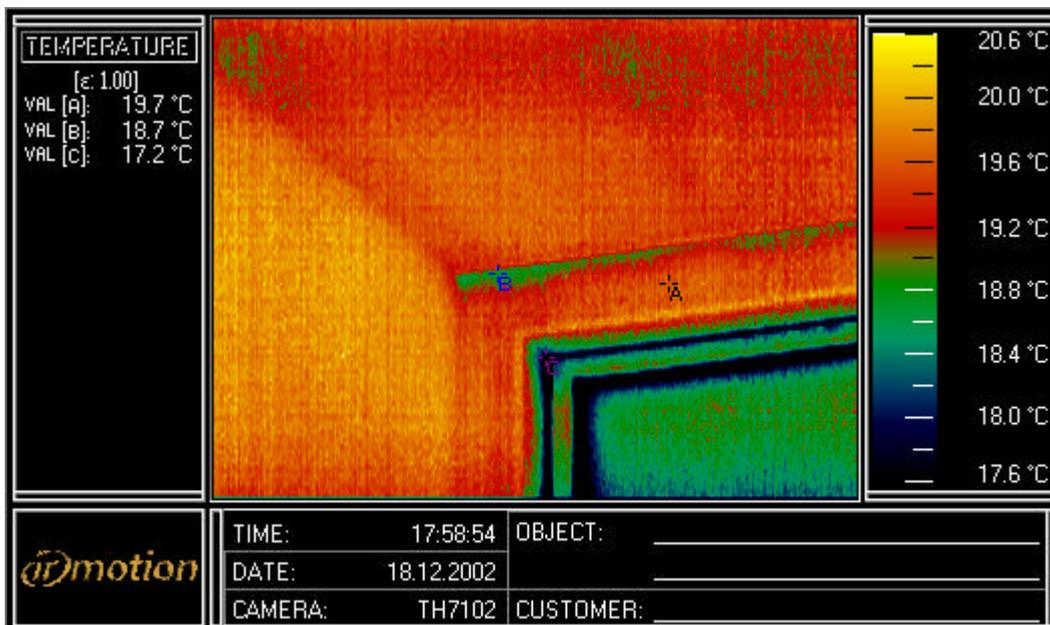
Wohnung Dachgeschoss links Schlafen.
